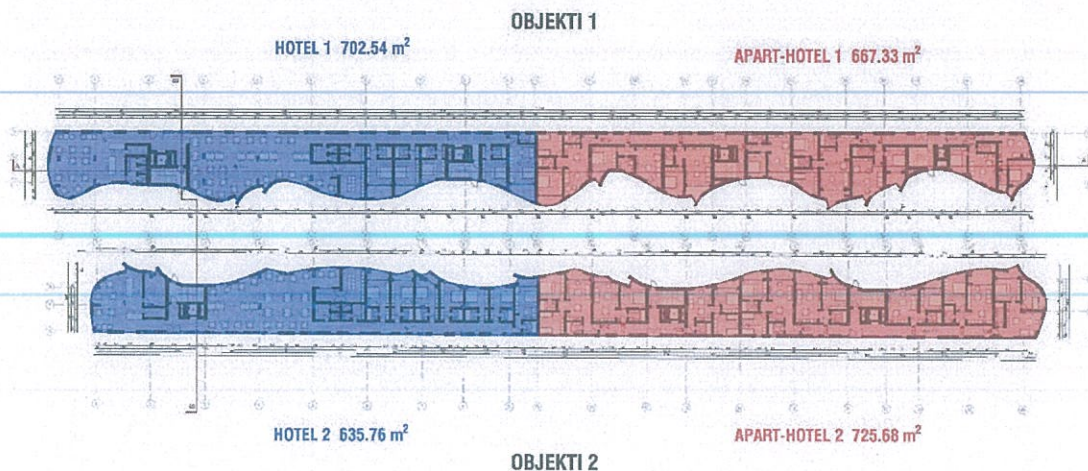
Planimetria e Katit Përdhe \_HOTEL DHE APART - HOTEL
